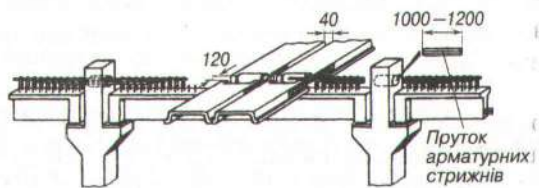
З'єднання збірно-монолітної конструкції каркаса будівлі
